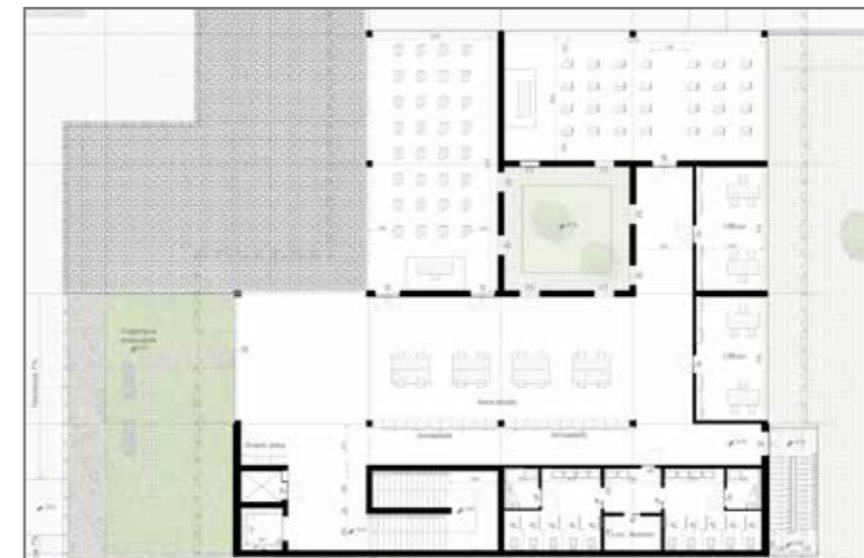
Pianta piano primo del Centro di Ricerca per il Restauro e la Conservazione
